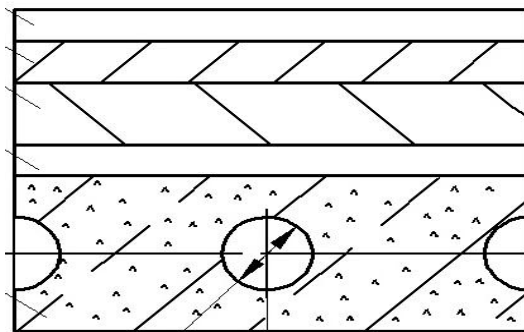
Эскиз перекрытия над неотапливаемым подвалом
